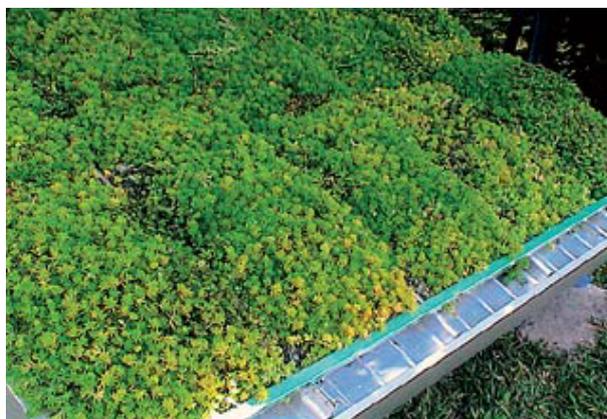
Sistema com telhas metálicas e módulos pré-fabricados
